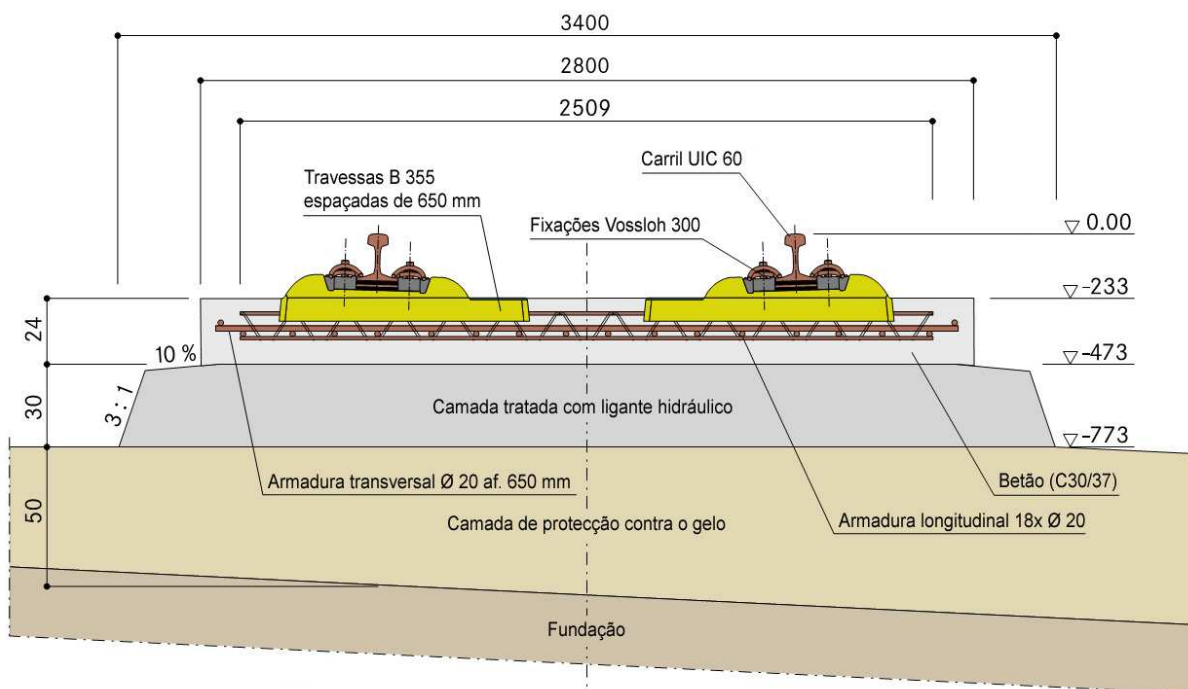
Secção transversal da via férrea em placa (RAIL.ONE, 2006)
